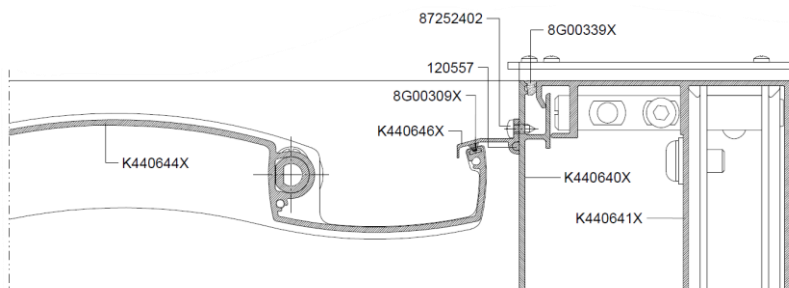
Montaż dolnego zakończenia dachu typu 1
